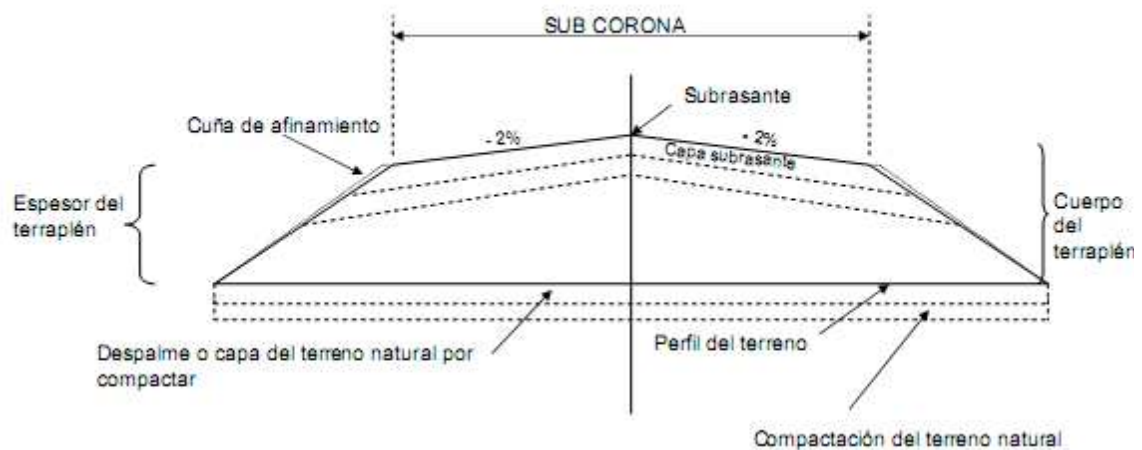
Sección de construcción de un terraplén en tangente por SCT
